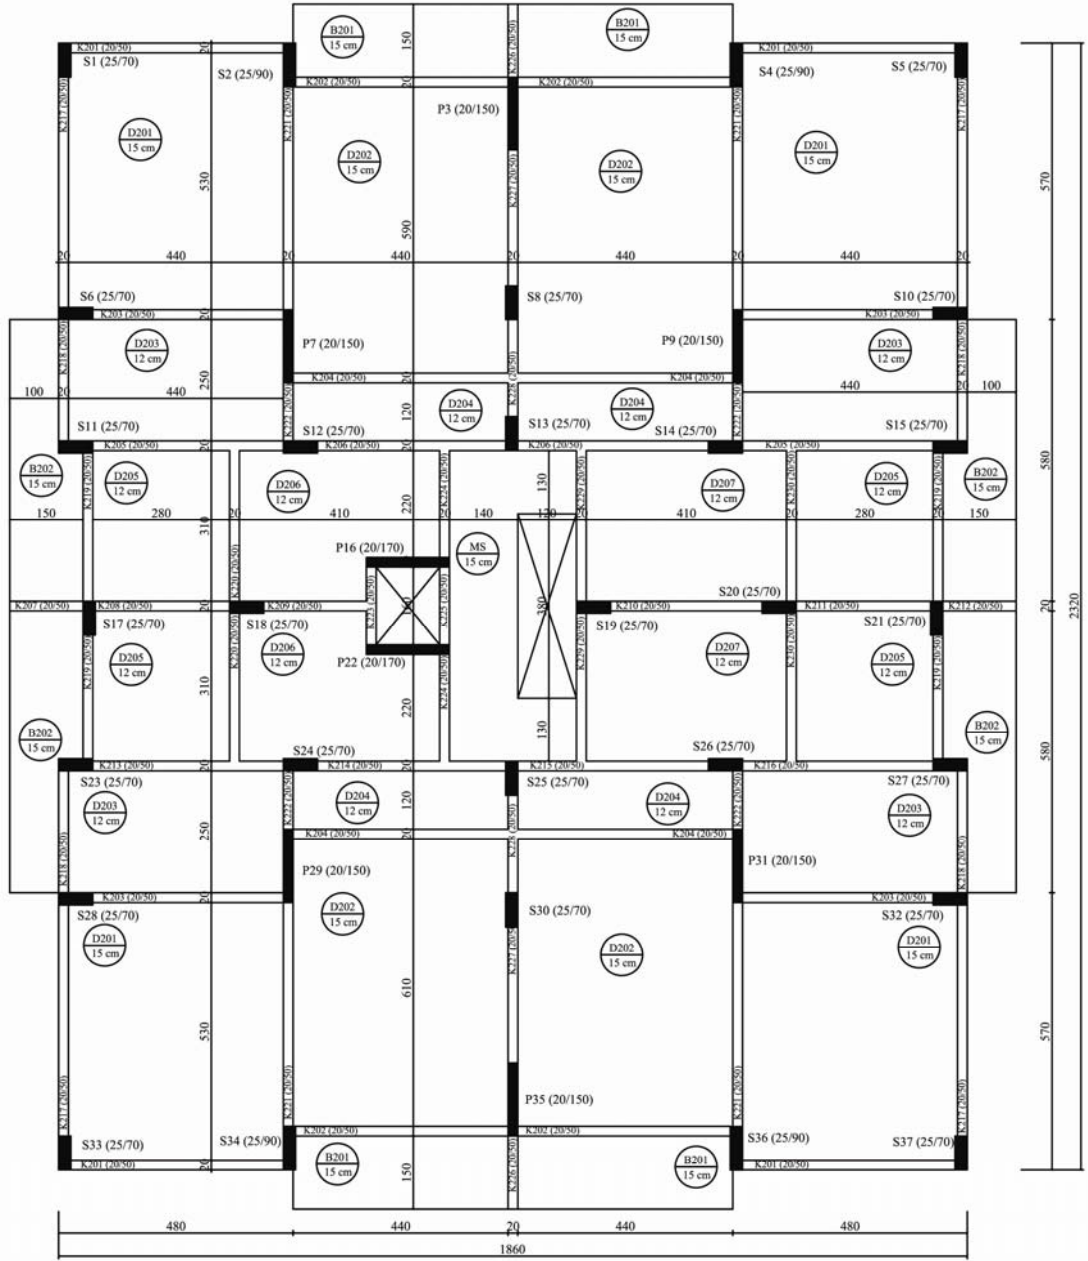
B7\_3'ün kat kalıp planı
